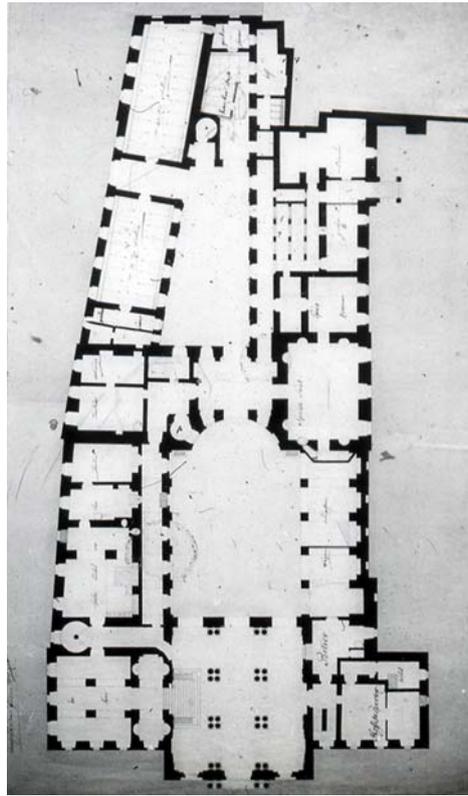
Gartenpalais Trautson, Grundriss
